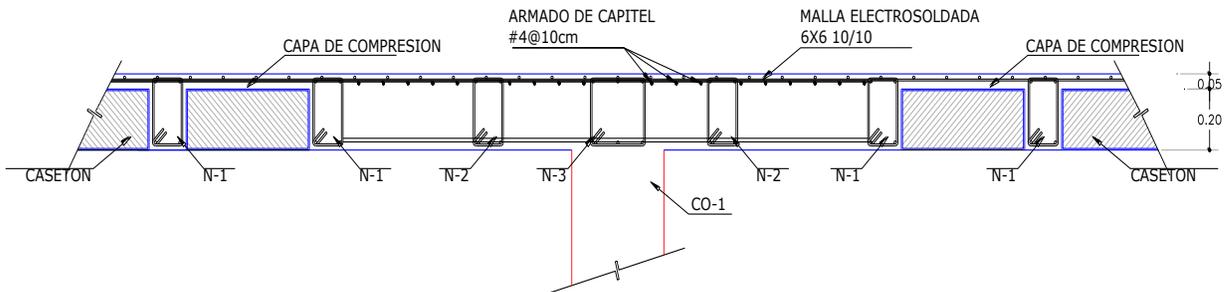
Secciones y Armados de Nervaduras Tipo.
